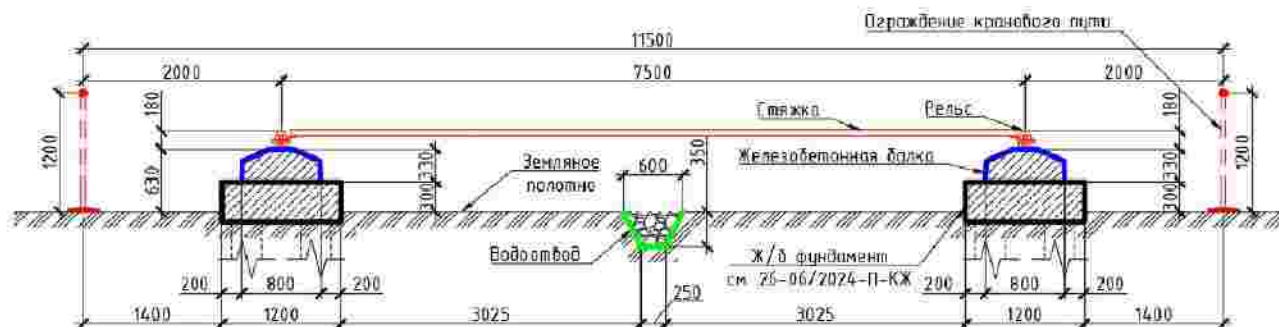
Устройство кранового пути на железобетонном фундаменте
